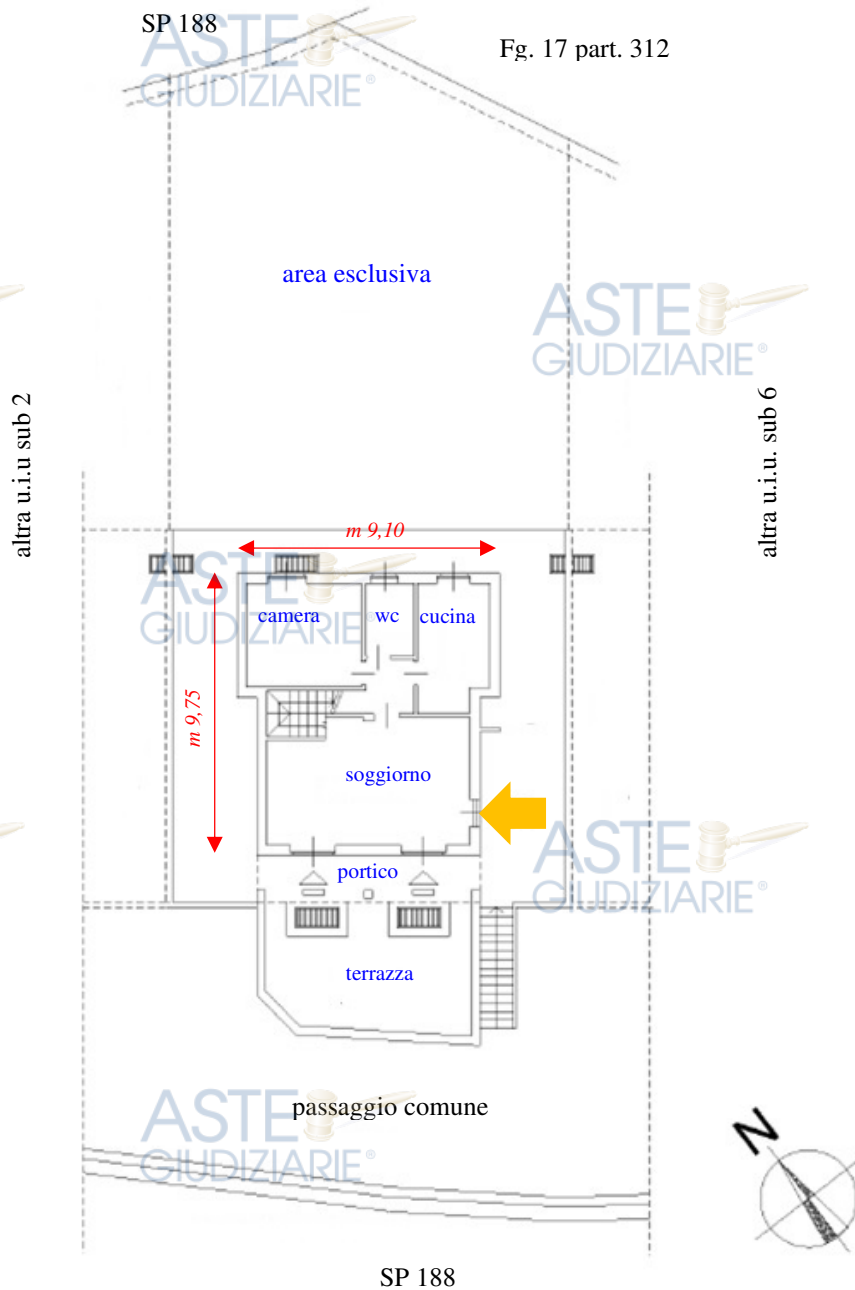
Planimetria non in scala del piano terreno del villino sub. 4 (anche All. n. 6)
